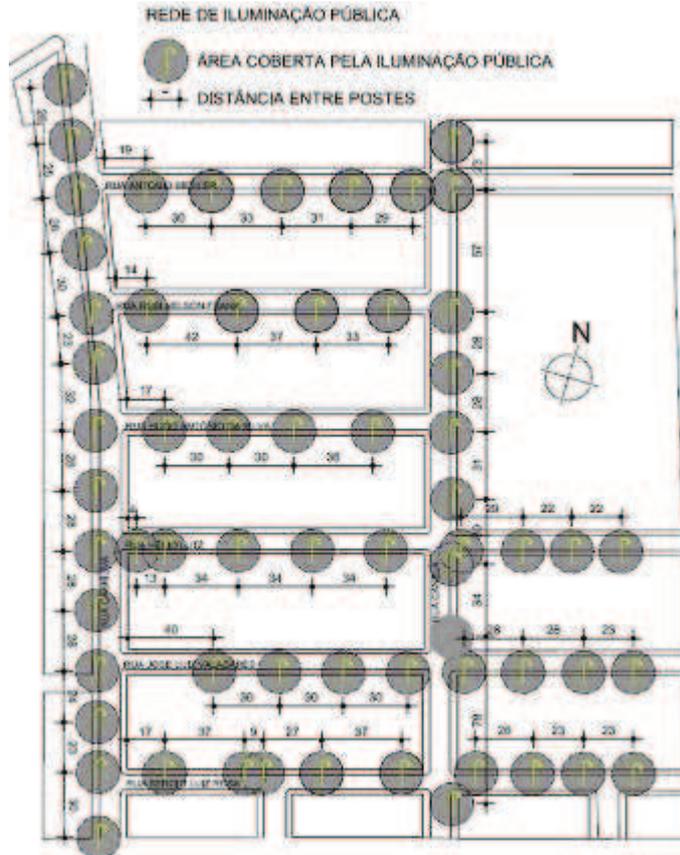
Implantação: Rede de Iluminação publica loteamento Bem-te-vi
